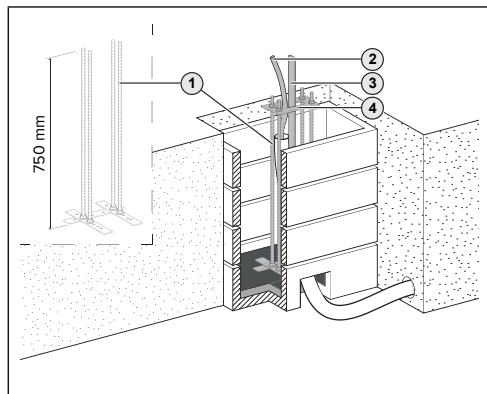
Inserire il set di montaggio per fondazione (esempio)
